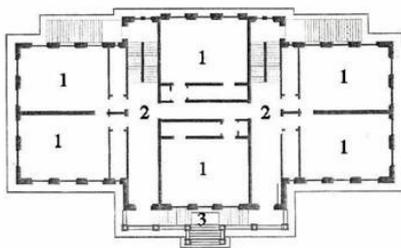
Planta primeiro pavimento da Escola Normal Prudente de Moraes (1895) São Paulo.
